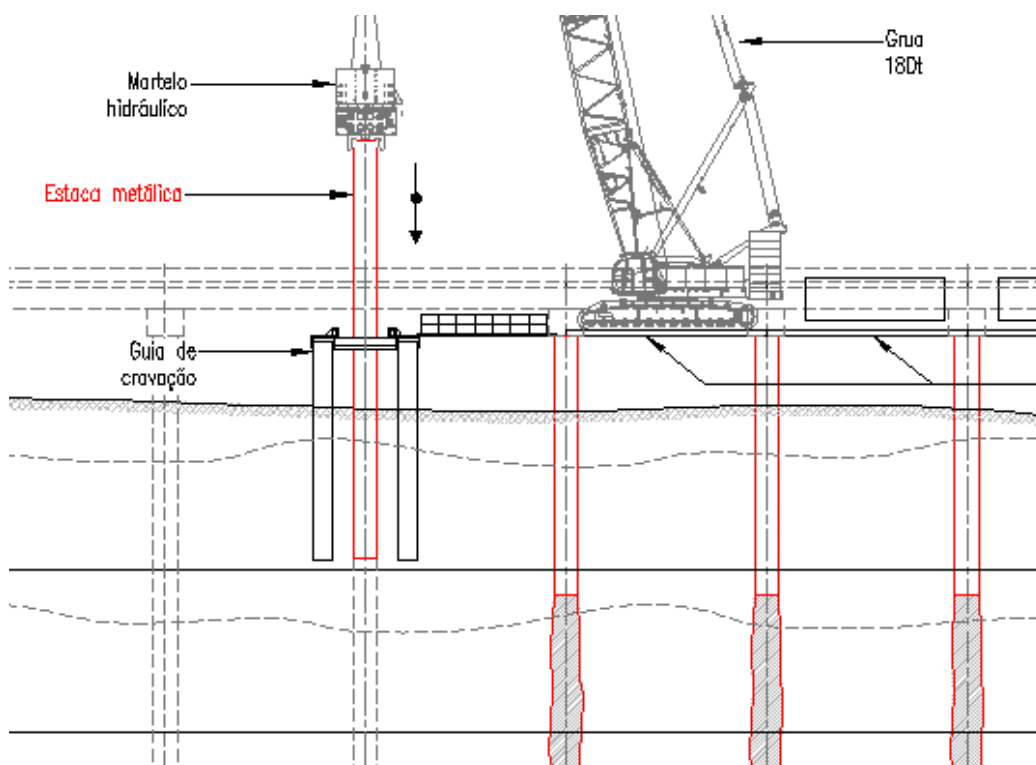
Fase 1 - Cravação de tubos de encamisamento metálico
